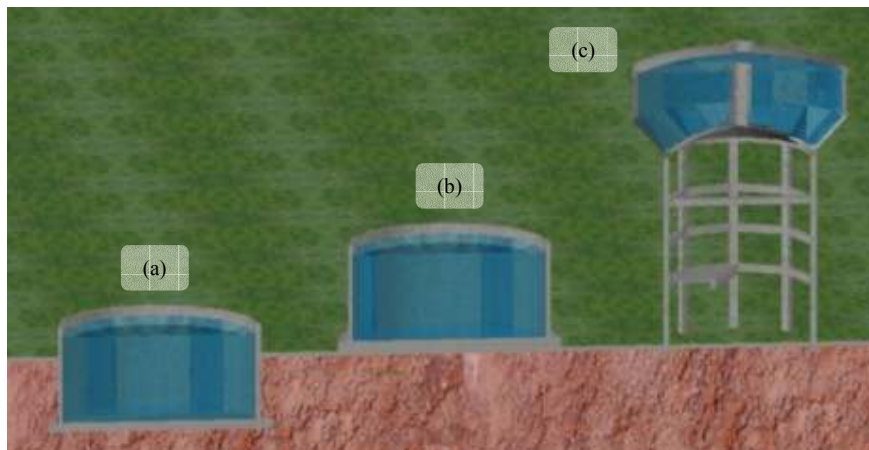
tipos de reservatório (corte): (a) enterrado (b) apoiado e (c) elevado.
